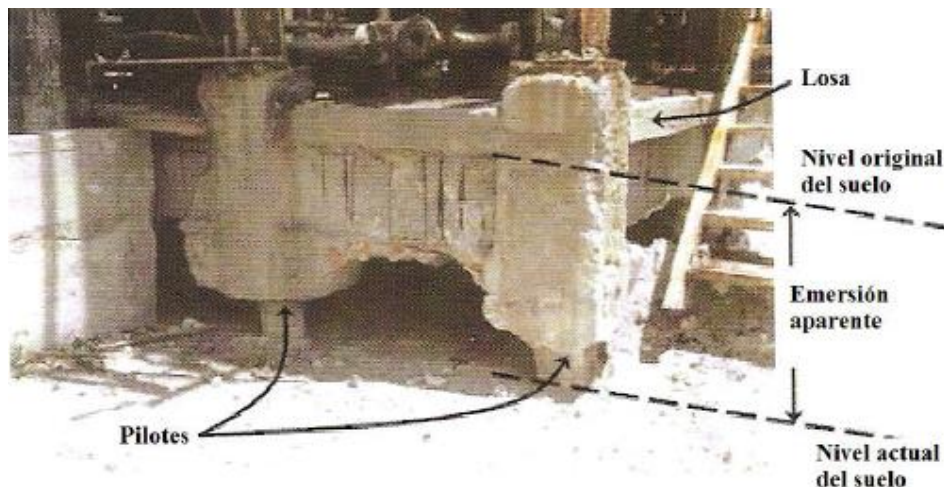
Emersión aparente en cimentación a base de pilotes de punta (Auvinet y Rodríguez, 2004)
